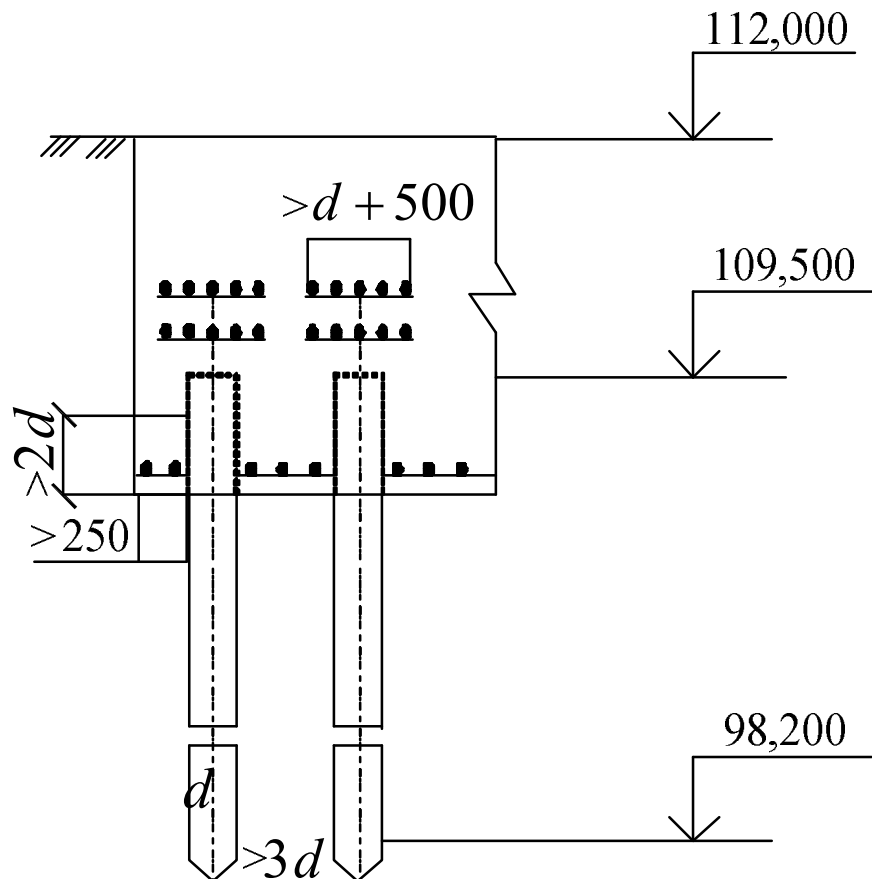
Расположение свай и один из способов объединения их с плитой ростверка
